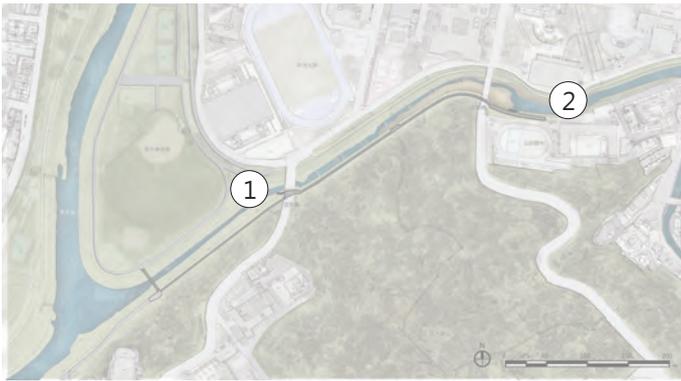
人文生態護育段 - 平面設施配置圖
